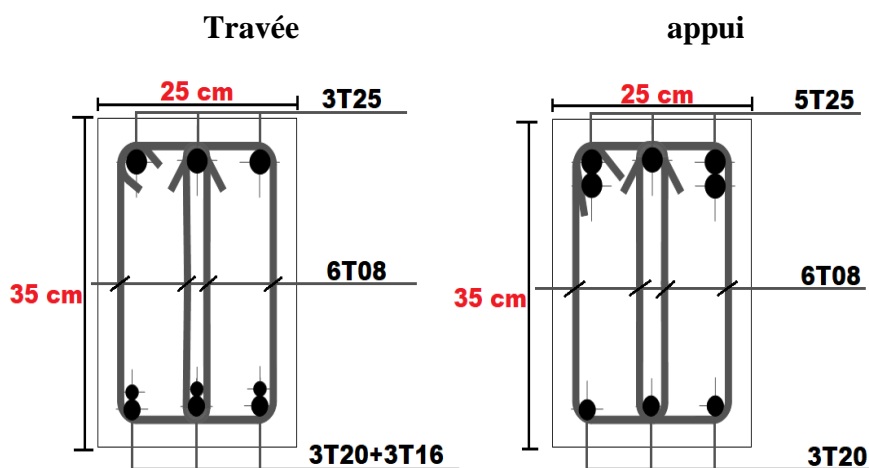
ferrailage des poutres secondaires 25×35 (terrace).
